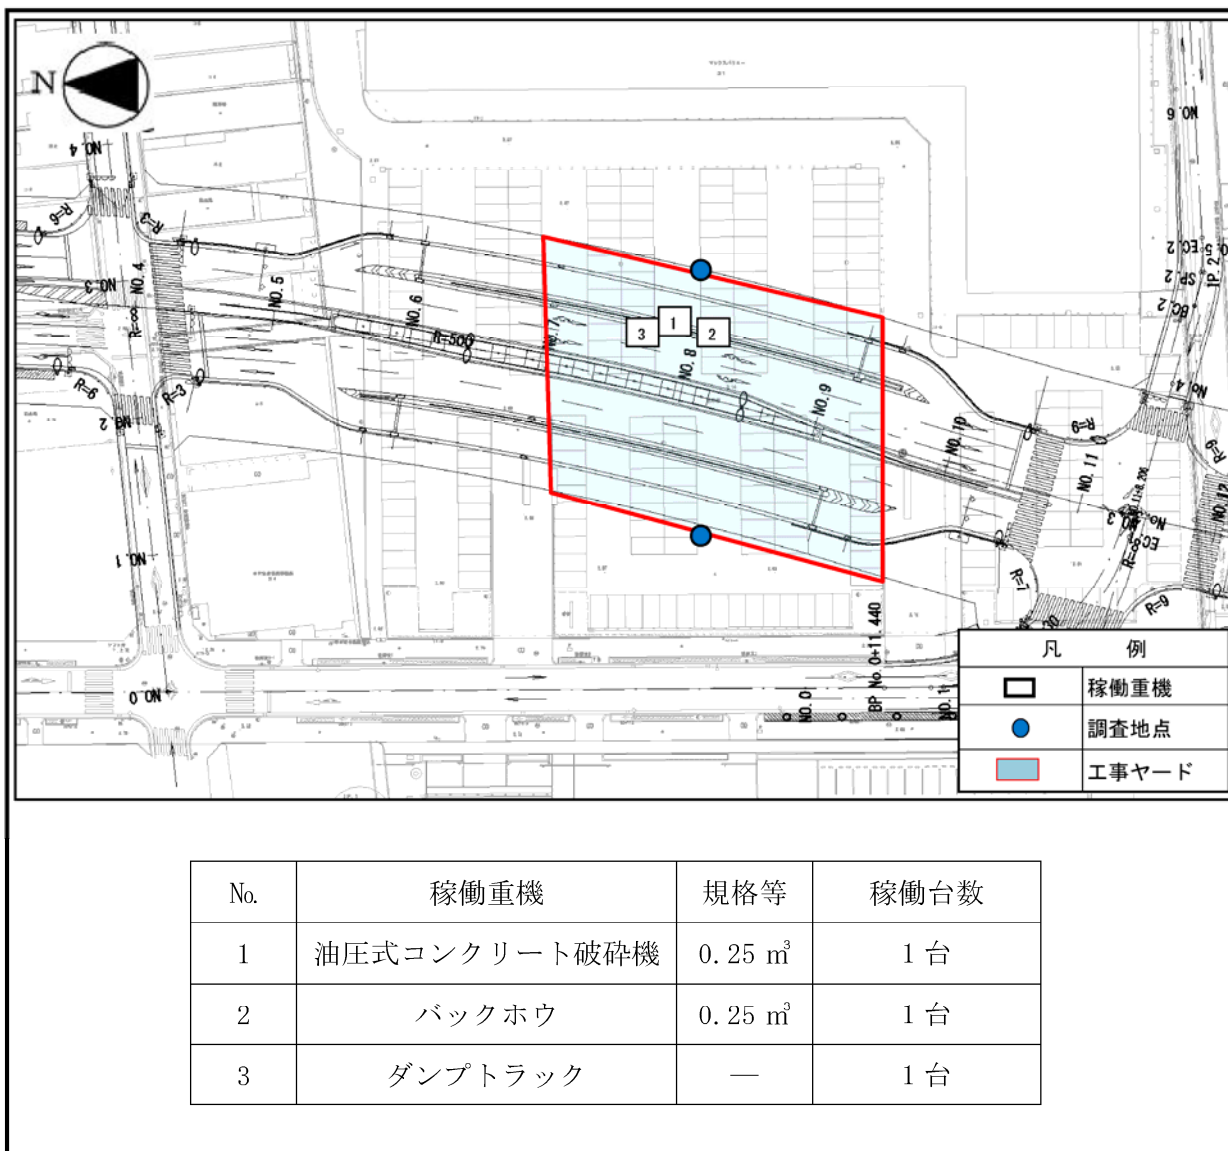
建設機械配置図（準備工：太閤地区平面部）
